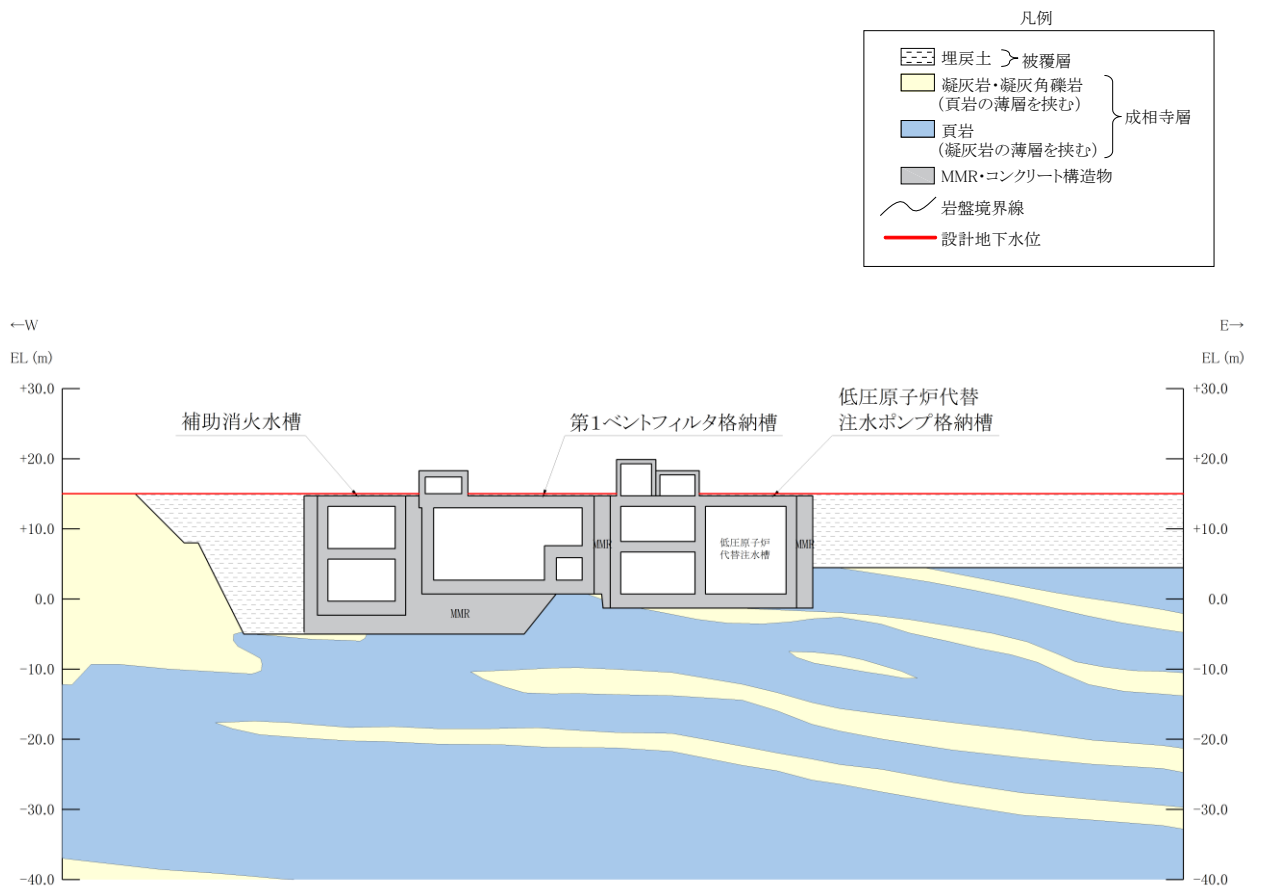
低圧原子炉代替注水ポンプ格納槽 評価対象断面図 (C-C断面)
